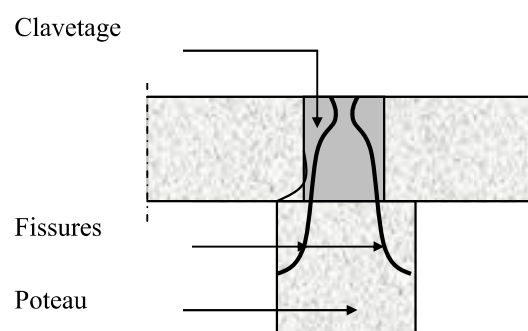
Fissures en tête de poteau servant d'appui aux poutres préfabriquées.
